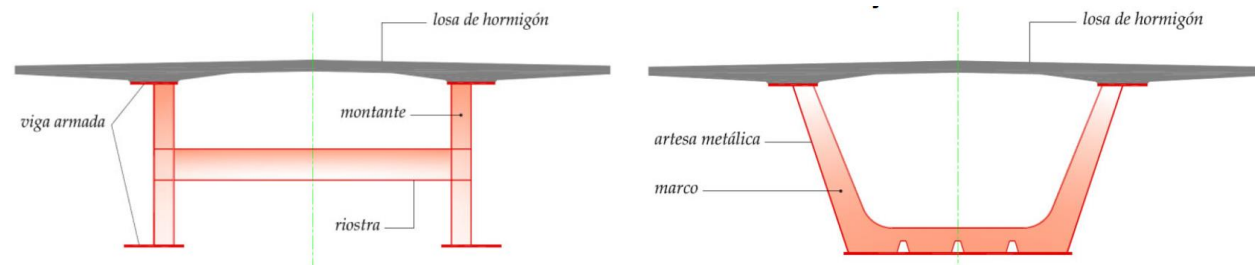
Secciones mixtas bi-jácena y cajón; Fuente: Diseño Estructural de Puentes, Salvador Monleón
